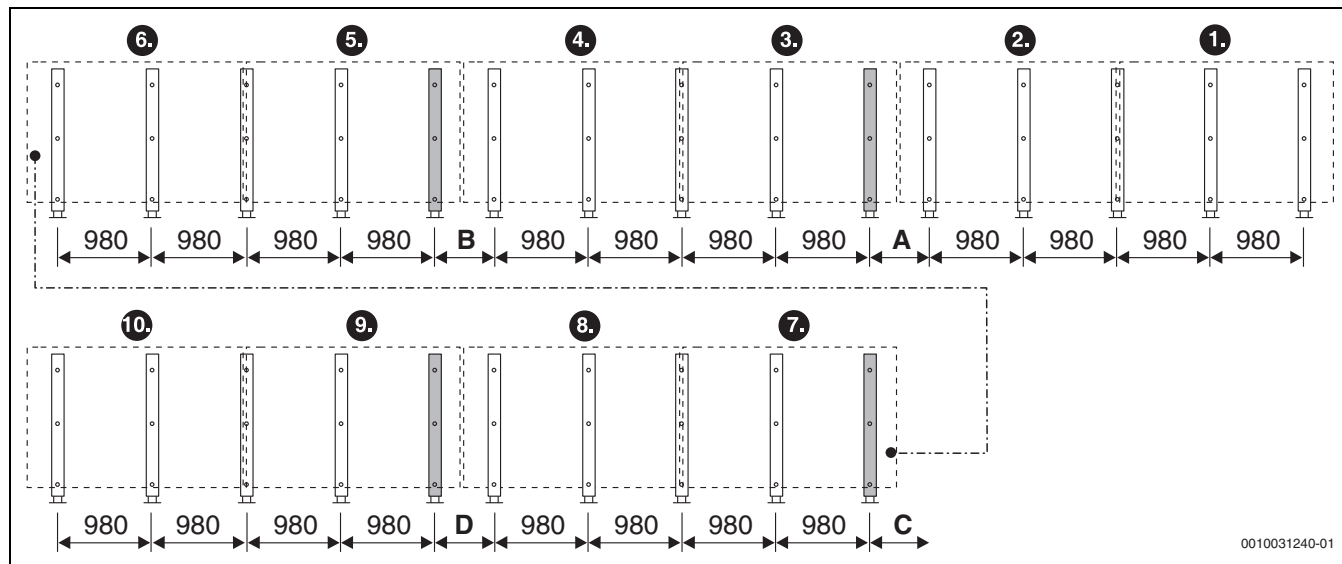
Základní provedení se zatěžovacími prostředky, 10 svislých kolektorů (rozměry v mm)
